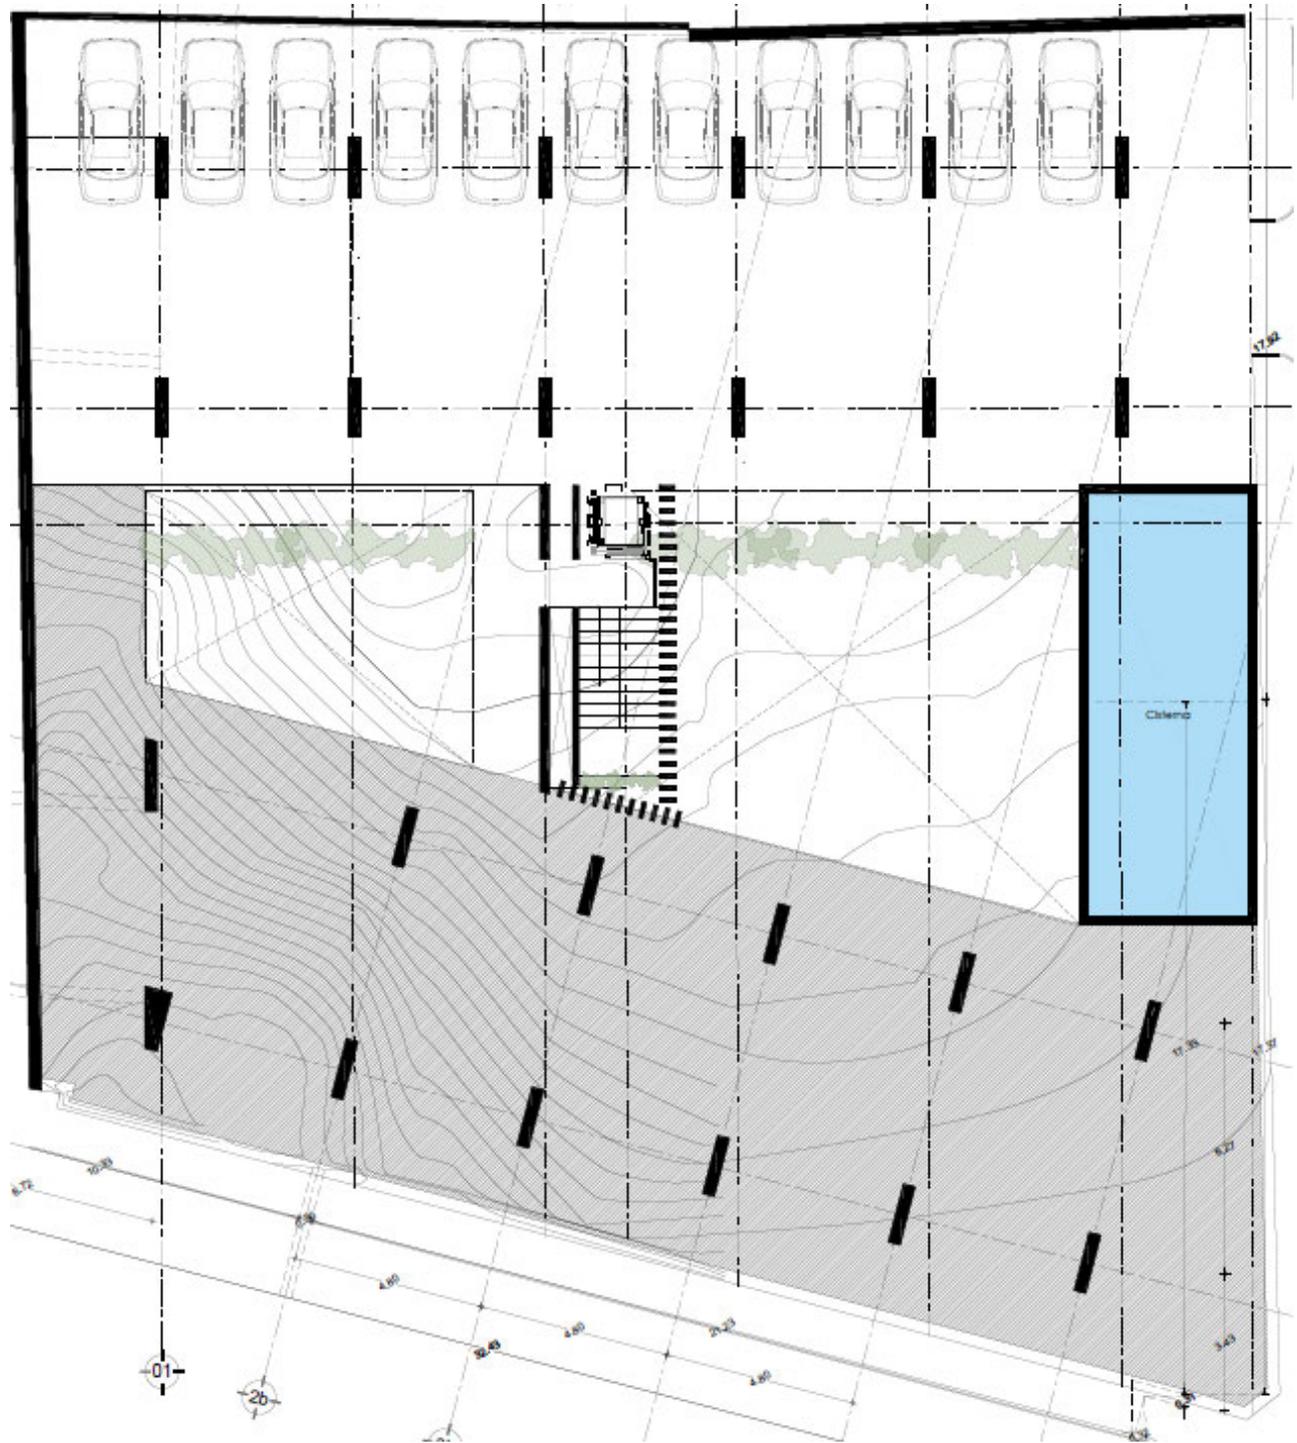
Planta Sótano 1 estacionamiento, Fuente: Plano Arquitectónico.
